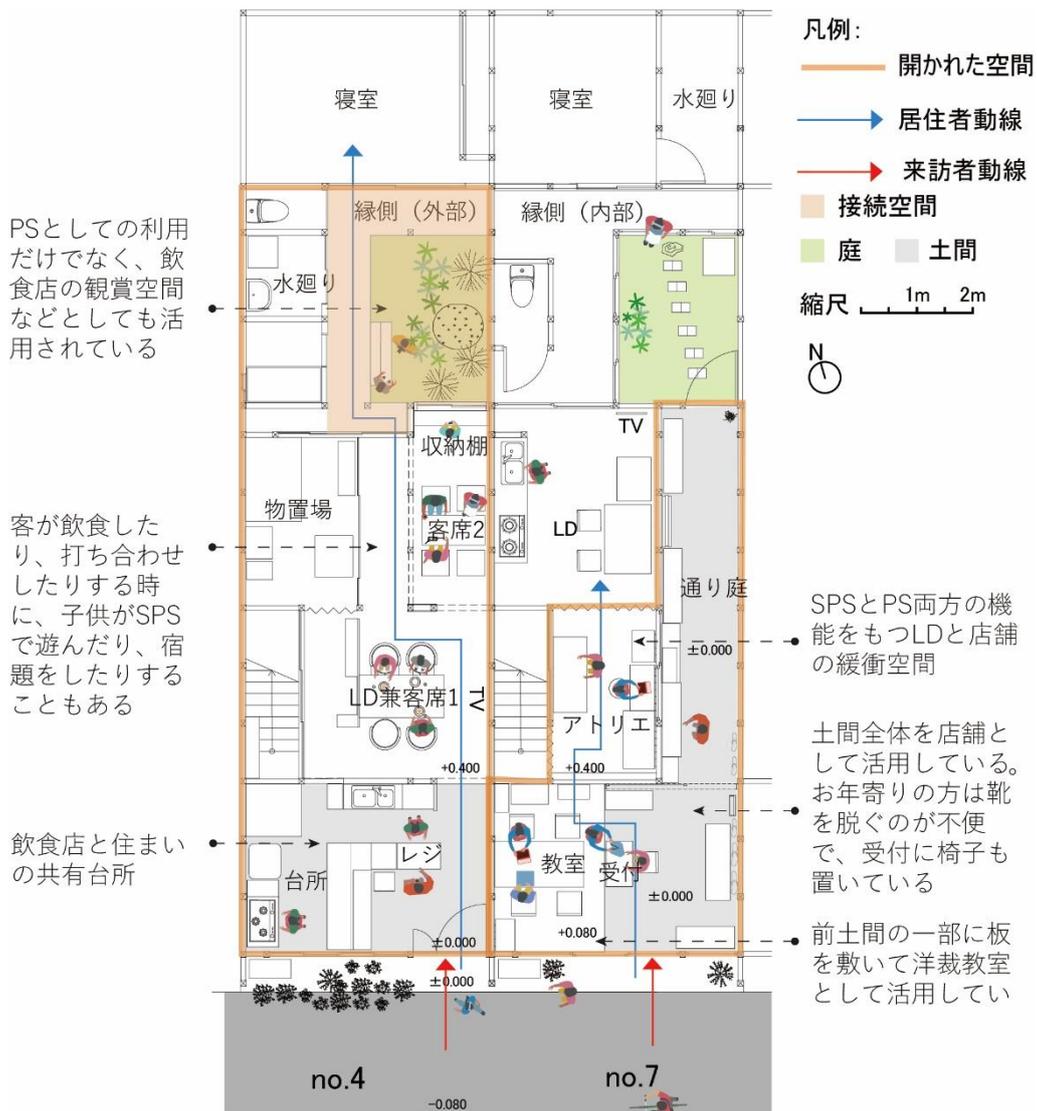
兼用 (no. 4) と時間差利用 (no. 7) の代表事例の平面配置図
